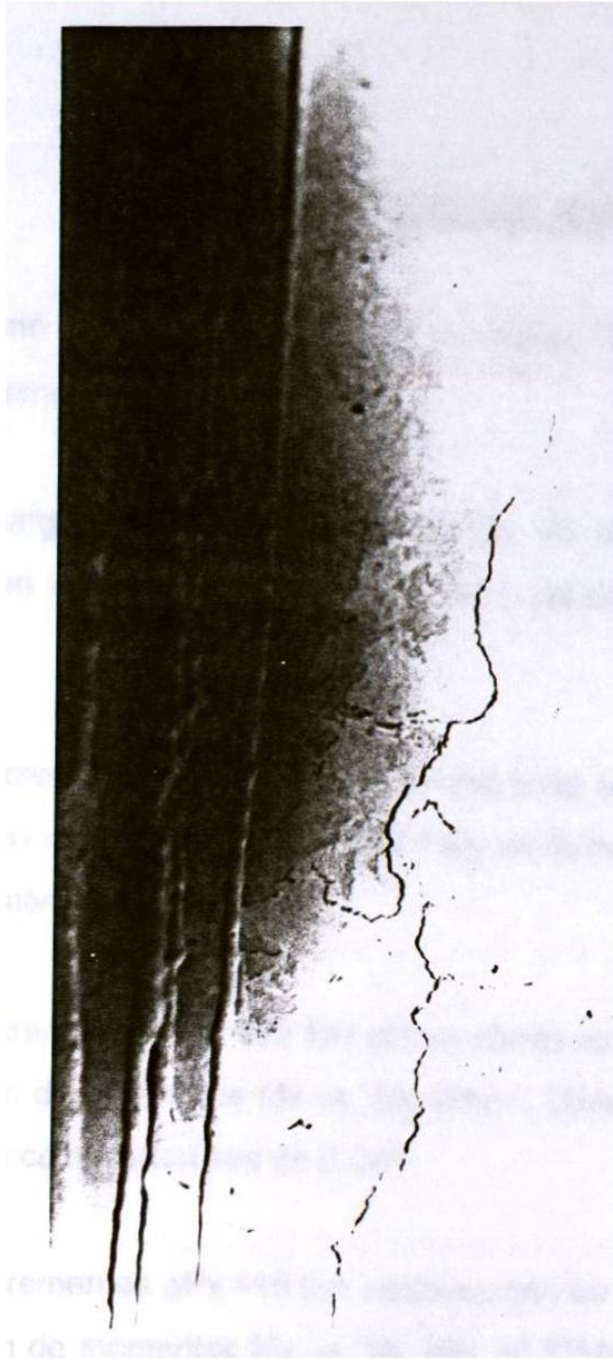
Se muestran grietas en la columna.
